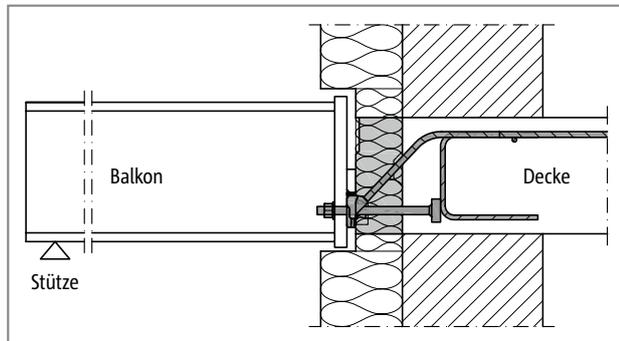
Schöck Isokorb® T Typ SQ: Anschluss an die Stahlbetondecke; Dämmkörper innerhalb der Außendämmung
